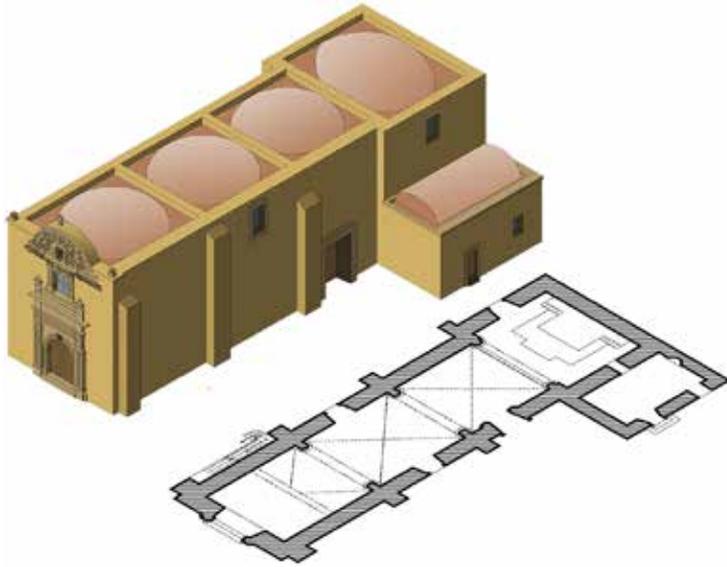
Dibujo y planta de Tlajomulco. Fuente: Elaboración propia, 2008.
